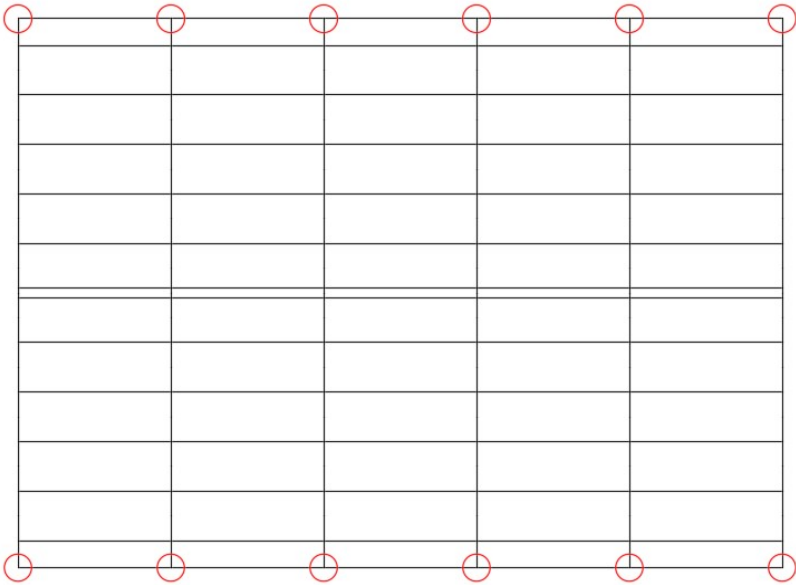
Vista en planta de la cubierta, resaltando las columnas donde se colocarán bajantes
